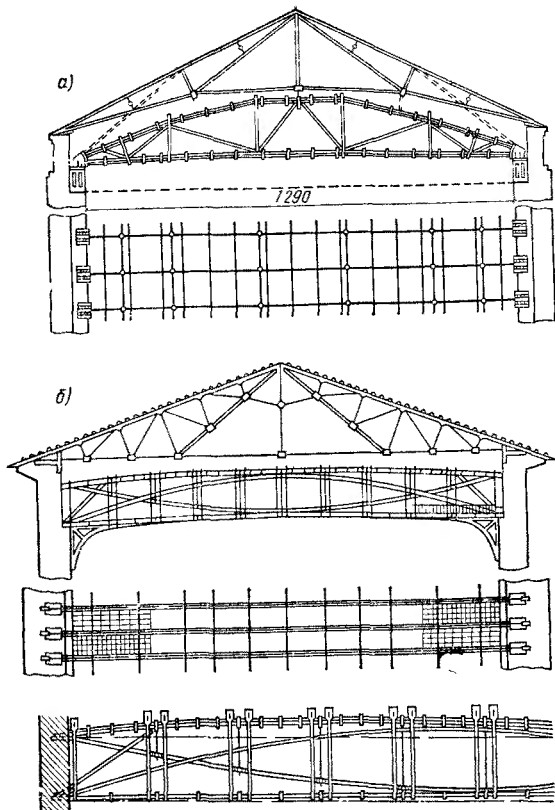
Перекрытие Зимнего дворца в Ленинграде (1837 г.)
